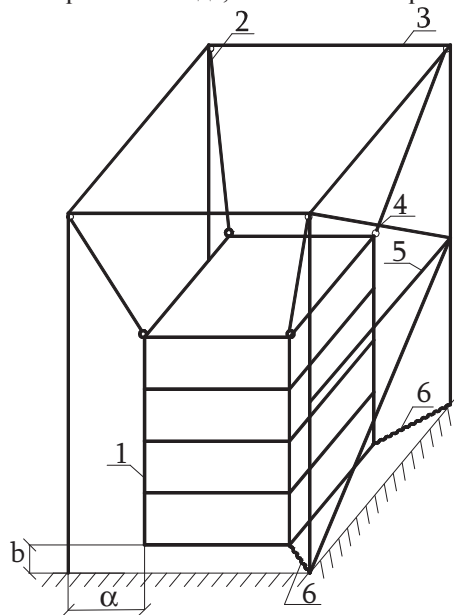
Схема подвески здания на четырехугольную в плане раму
